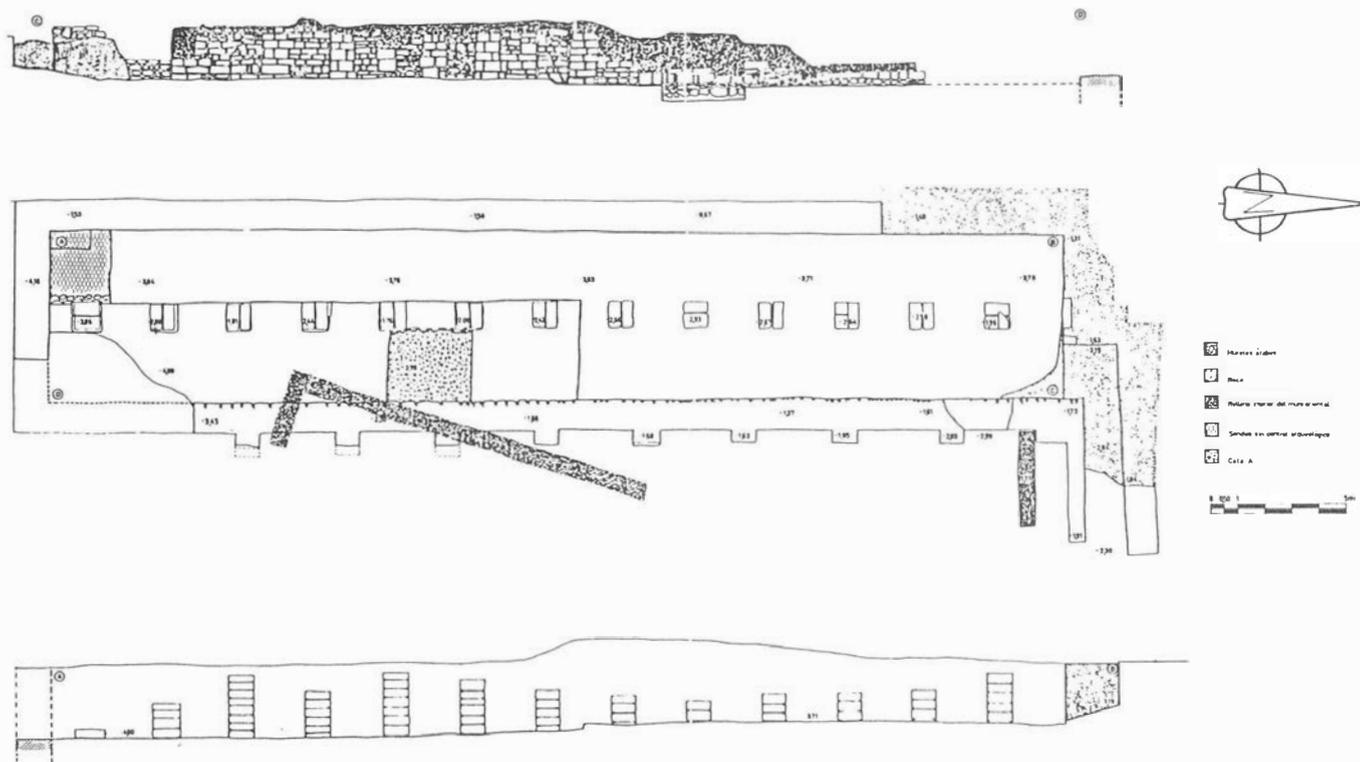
Planta general de la estructura. Alzado del paramento interior del muro oriental y alzado de la hilada de pilares centrales que divide la estructura en dos naves.
